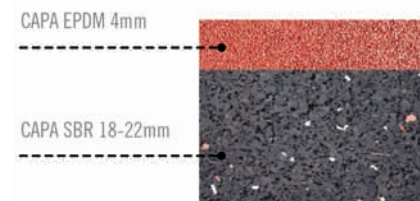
CAPAS DEL PAVIMENTO A BASE DE CAUCHO
